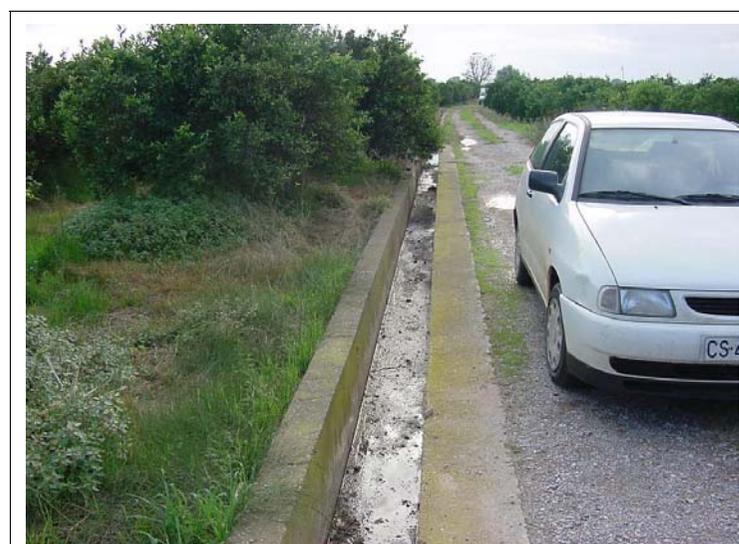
Acequia de 50x60 y murete de 20x40 cm.
